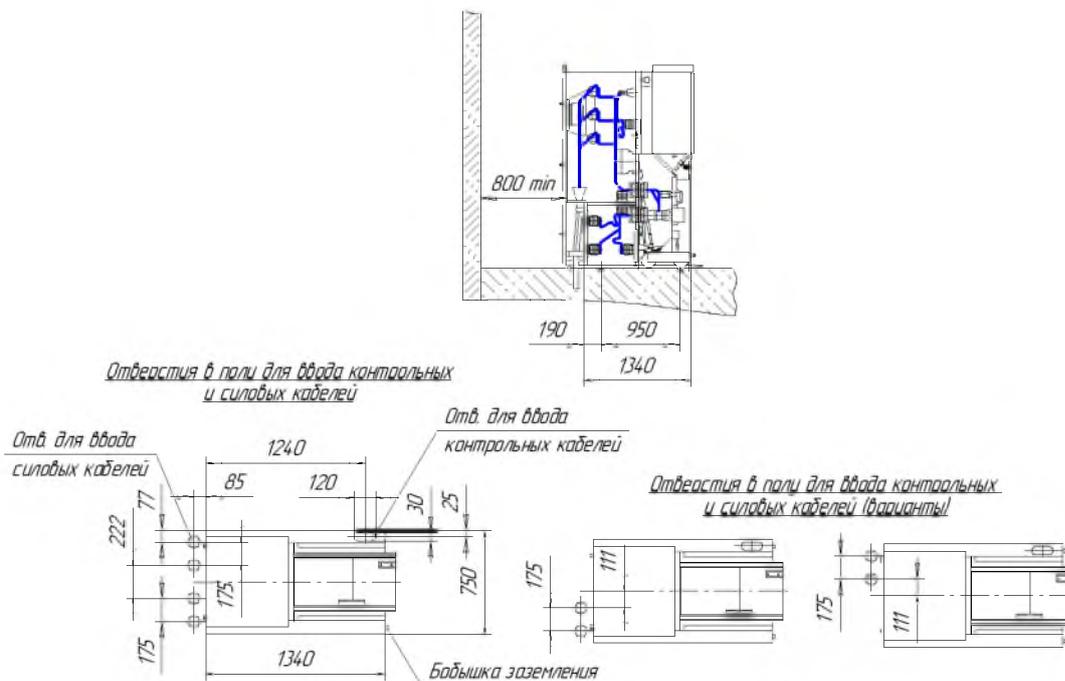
Установка шкафов кабельного ввода снизу внутри шкафа на токи 630...1600 А на фундамент
